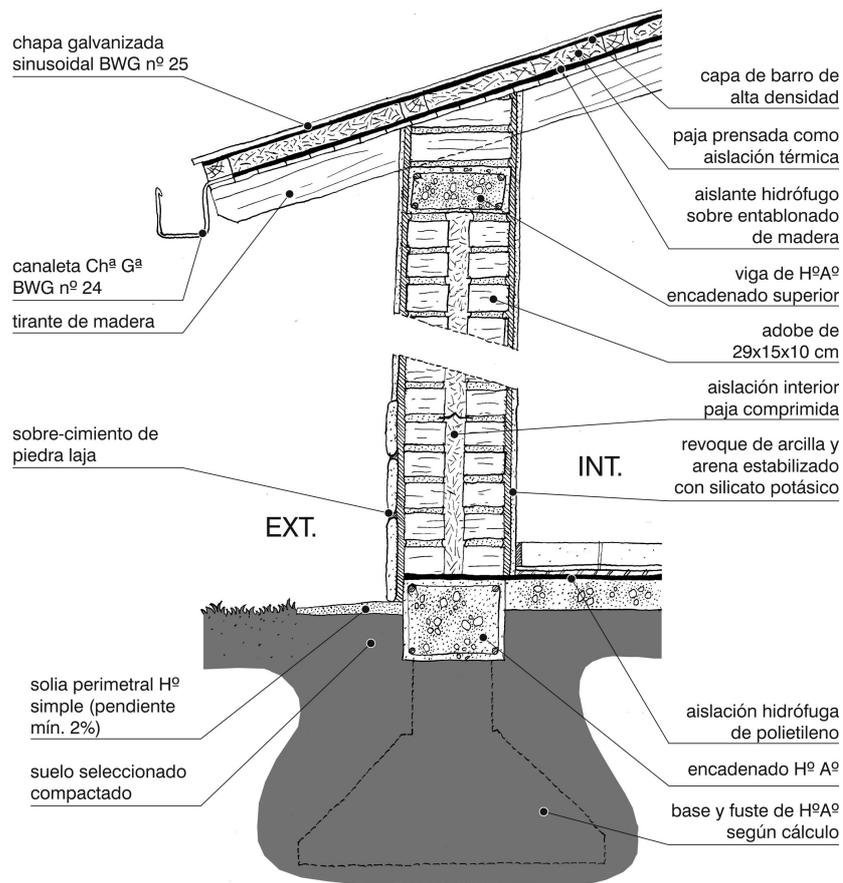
Corte del muro de adobe para la vivienda en Buenos Aires.
